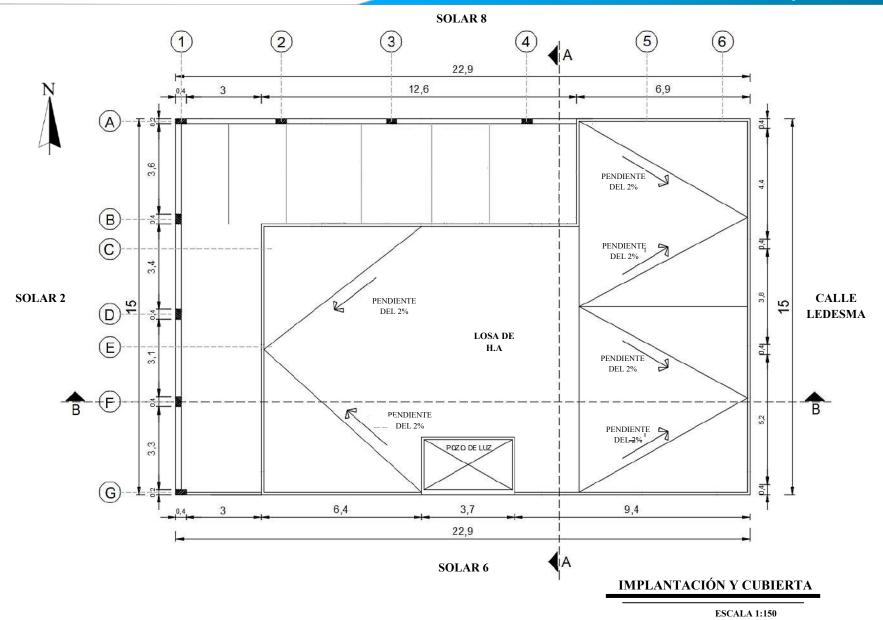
Plano de implantación y cubierta. Fuente: Elaboración de autores.
